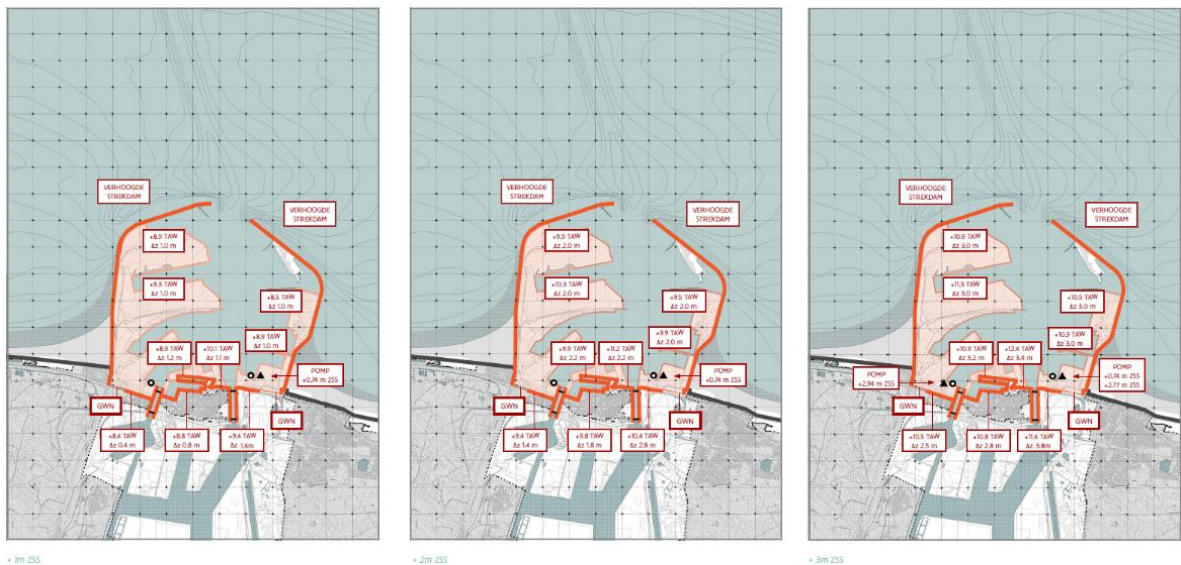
Het alternatief met de open voorhaven van Zeebrugge.
